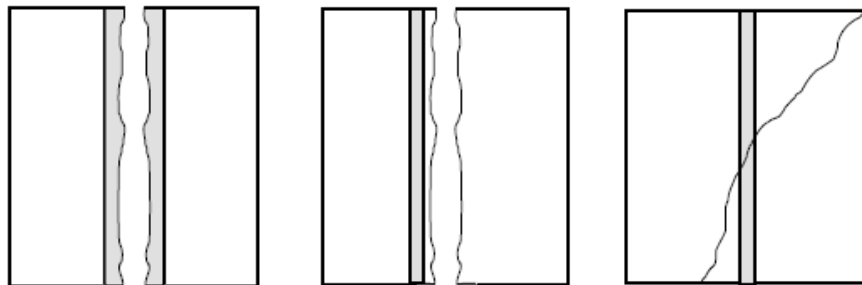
Thyerja e muraturës në llaç, thyerja e muraturës në njësinë muratuese, paraqitja e plasaritjes diagonale në mes të njësisë muratuese dhe llaçit.
